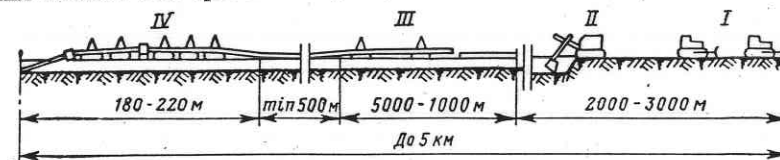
Схема выполнения работ по строительству трубопровода в пустыне:
